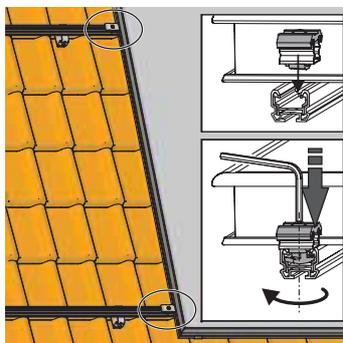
Inserire la piastrina di bloccaggio doppia
